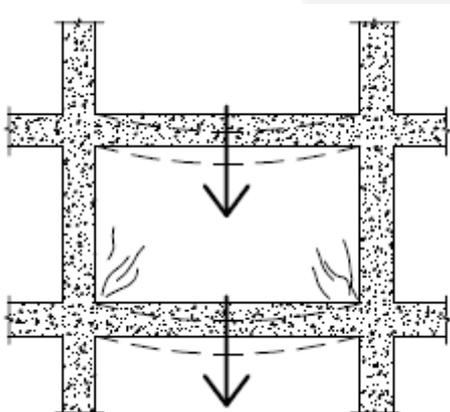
Fissuras por deformação em estruturas de concreto armado
